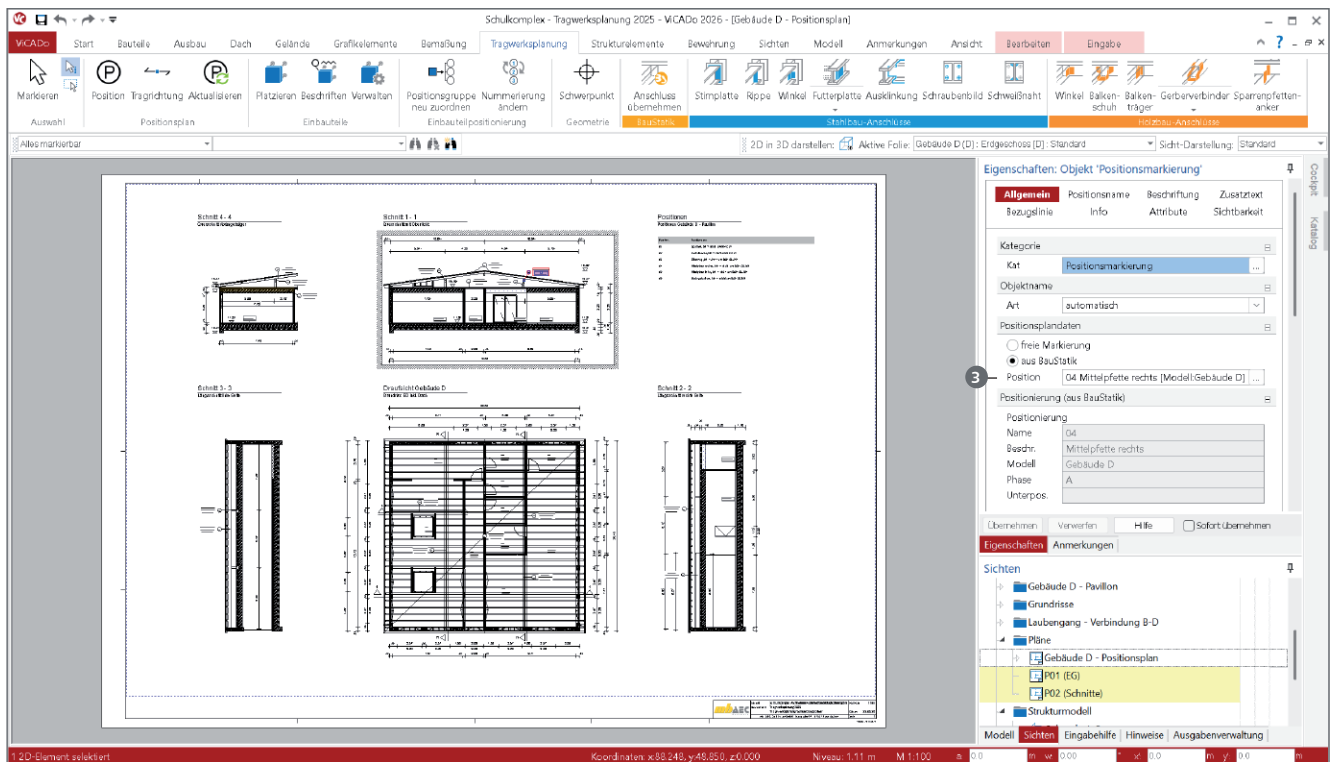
Positionsplan in ViCADO mit Positionsplandaten aus der BauStatik
